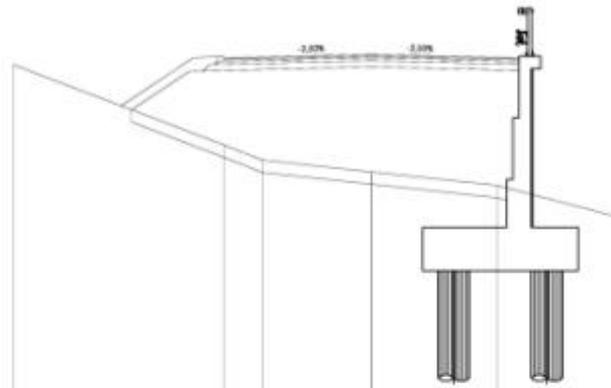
Sezione Longitudinale del Ponte Ries (ns. elaborazione da tavola T01VI03STRDI01\_A\_Pianta impalcato, sezione longitudinale e dettagli del progetto definitivo).
